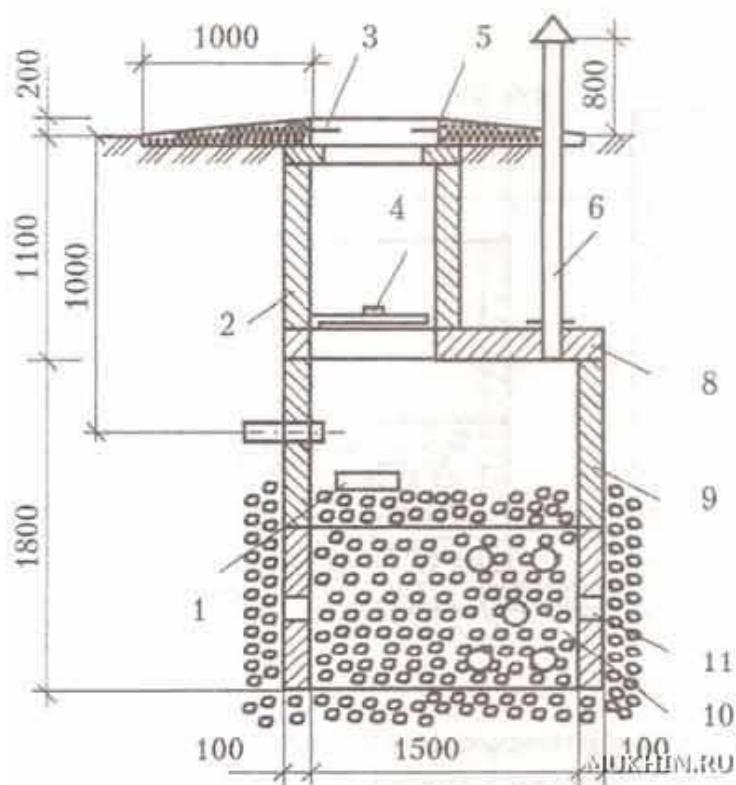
Фильтрующий колодец, смонтированный из железобетонных колец (размеры в мм): 1 — водоотбойная доска; 2 — лаз из железобетонного кольца диаметром 700 мм; 3 — люк чугунный, 4 нижняя деревянная крышка; 5 — опорное кольцо под люком; 6 — вентиляционный стояк; 7 — плита перекрытия; 8 — верхнее железобетонное кольцо; 9 — нижнее железобетонное кольцо; 10 — засыпка; 11 — отверстия.
